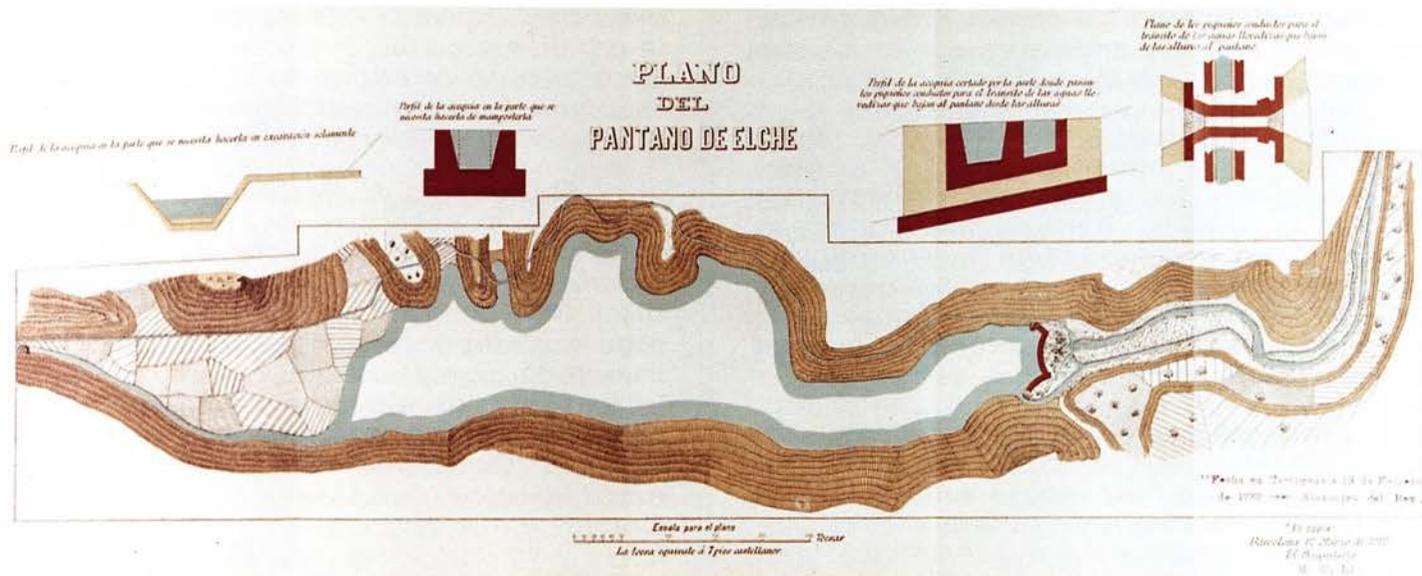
Plano del Pantano de Elche. (Fuente: Ibarra Ruiz).
